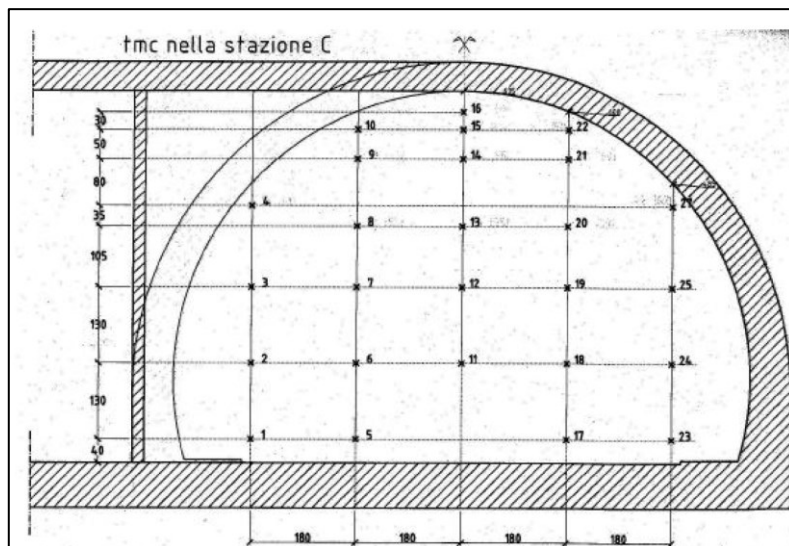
Disposizione delle termocoppie nel tunnel reale (sezione C, 0 m dal focolare).
